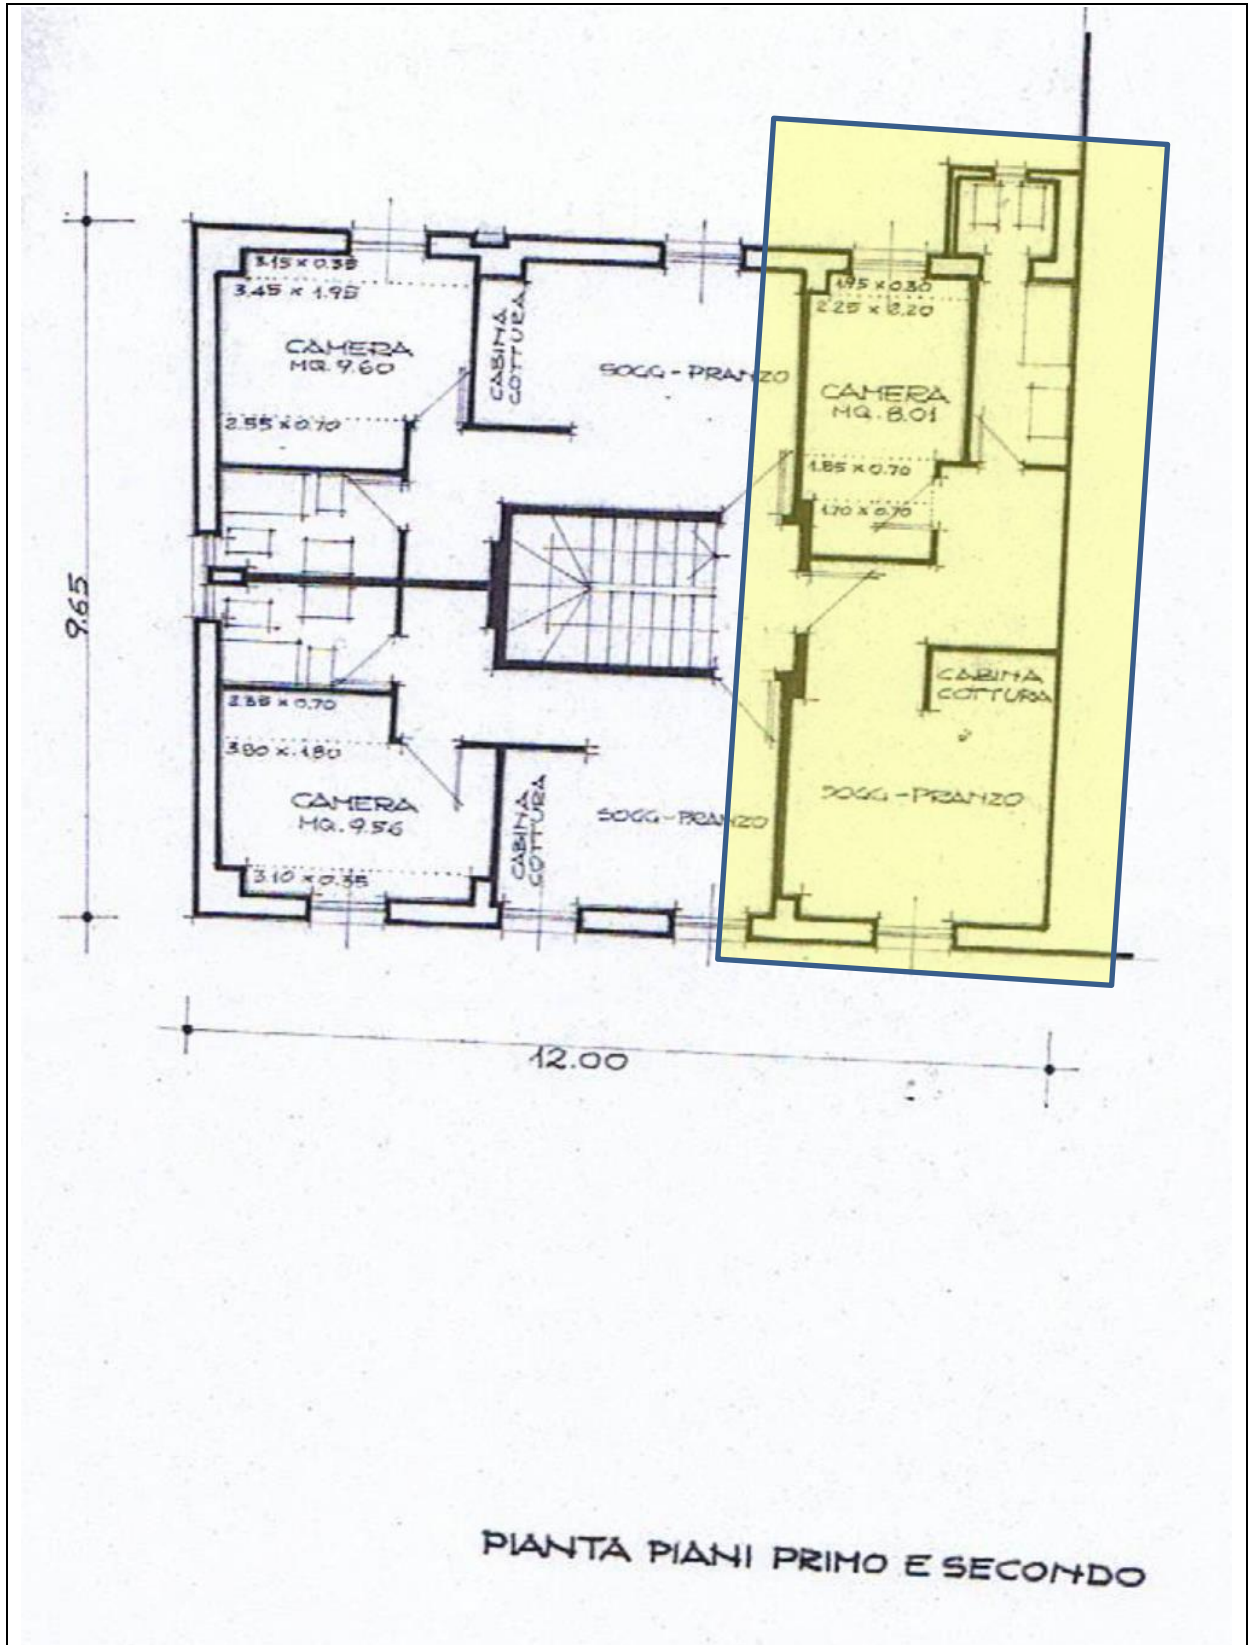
Stralcio rappresentazione piani correnti 1 e 2 allegata a variante aut. 11430 del 28/06/1976
